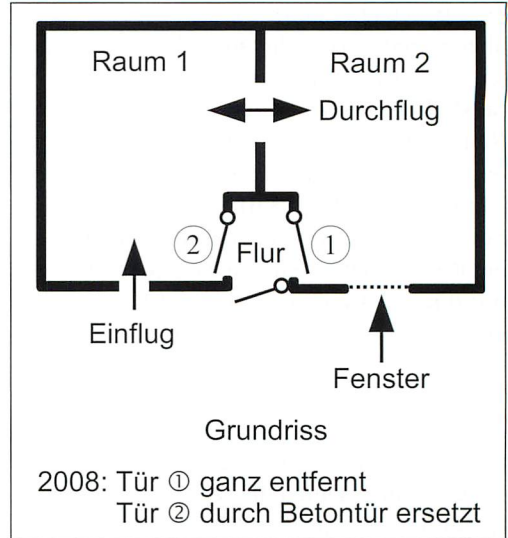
Grundriss des Winterquartiers Nr. 13: Dübbeckold Heidehauskeller.
